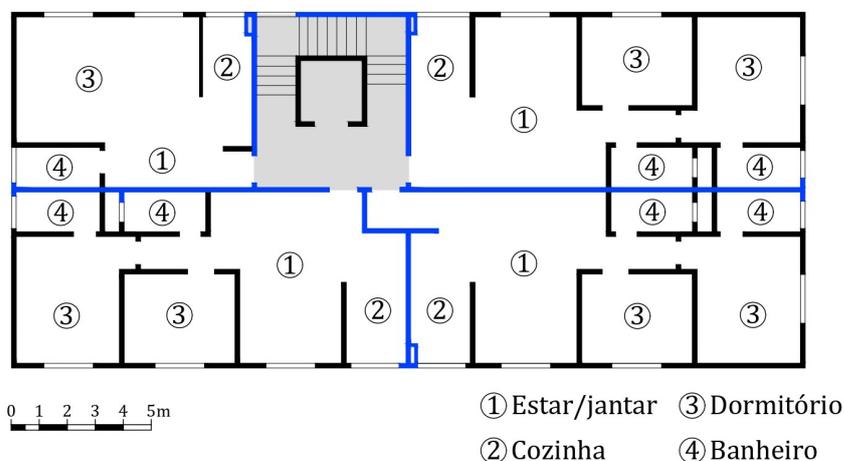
Planta do Objeto de estudo 9. Esquema sem escala.
